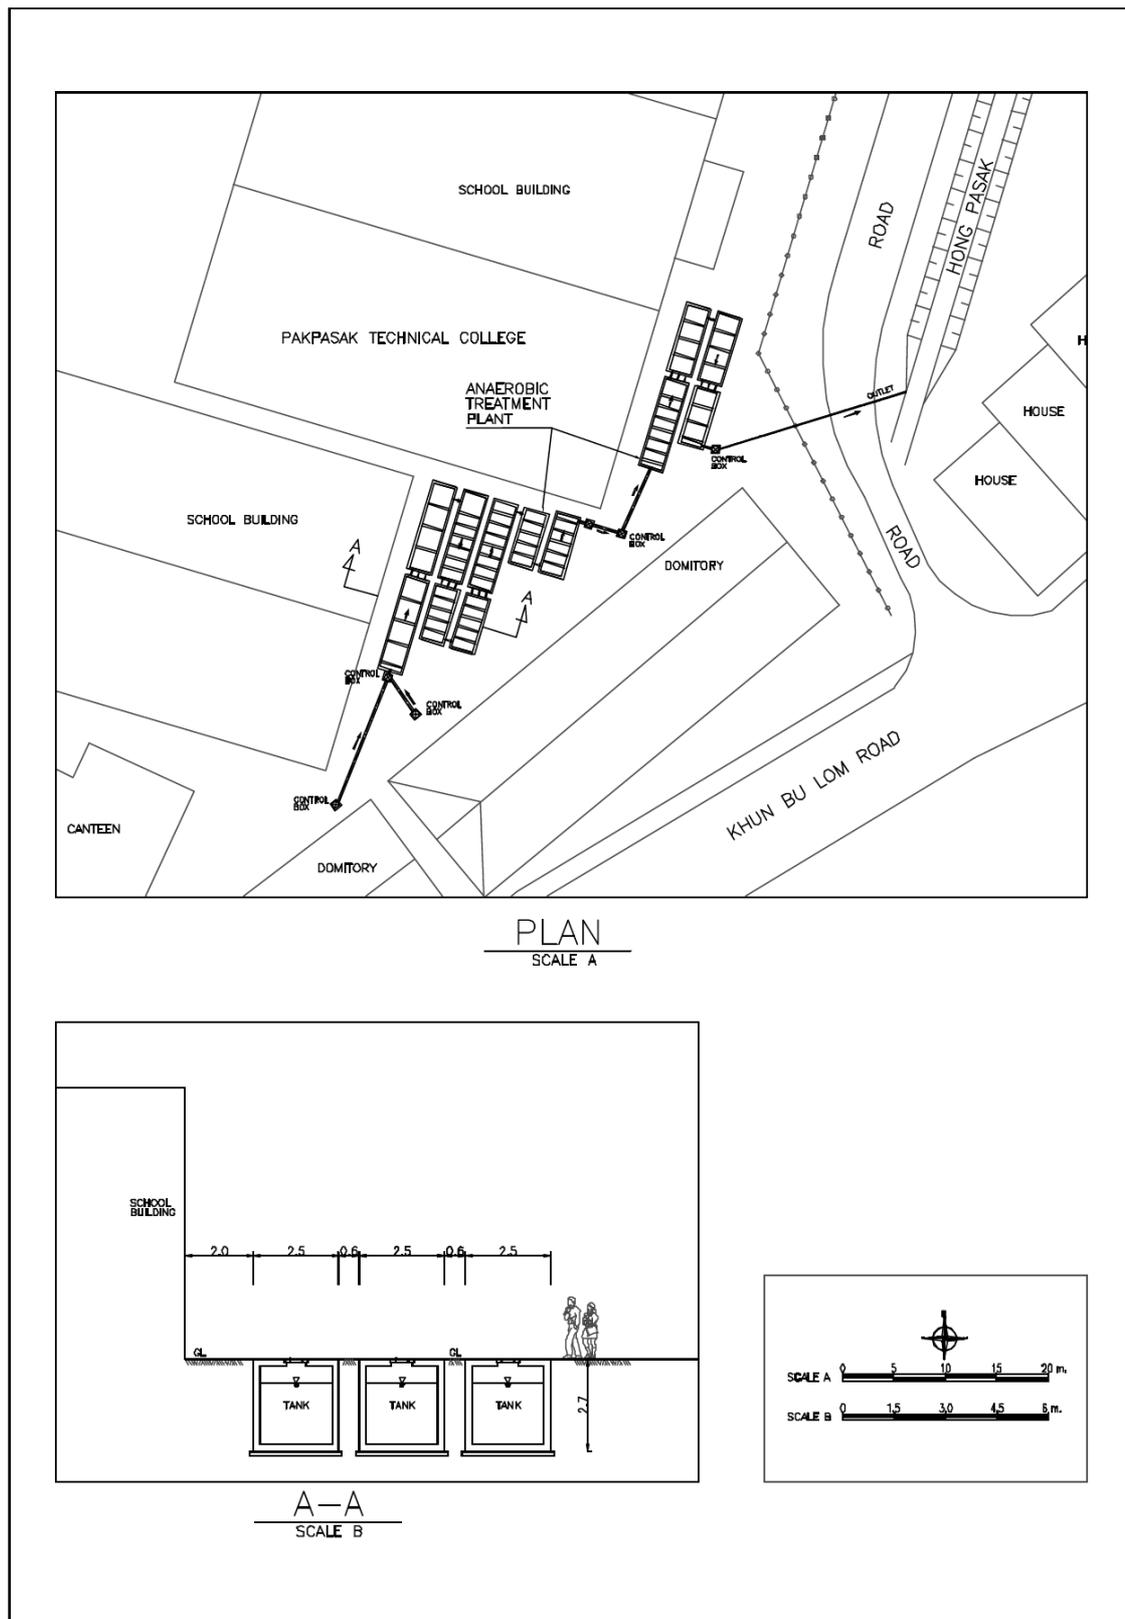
簡易処理施設(T1)の平面図および標準断面図
